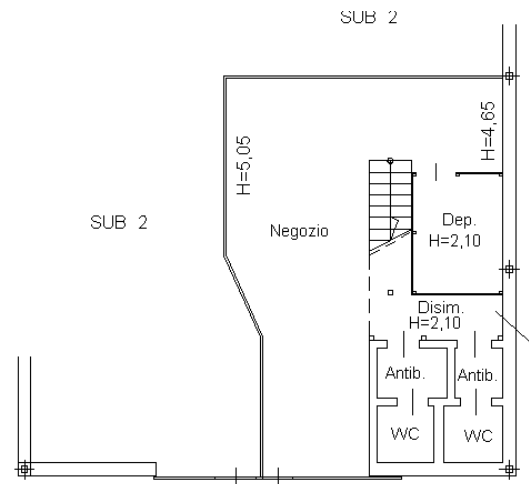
LOTTO 3 planimetria catastale piano terra sub 3
